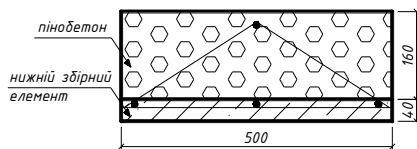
Поперечний переріз збірно-монолітних залізобетонних плит перекриття із використанням пінобетону
